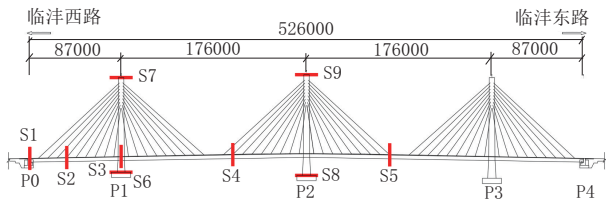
西安沣邑大桥立面布置图与加载控制断面(单位:mm)
